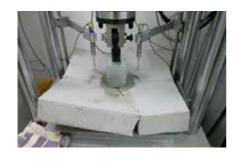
Pruebas especiales para hormigón proyectado: Pruebas de absorción de energía de hormigón proyectado reforzado con fibra según EN 14488-5.
